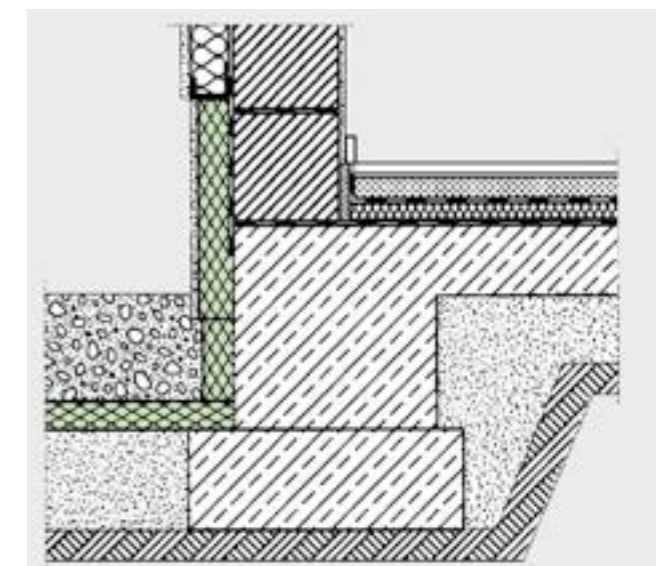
Possibilità di isolamento delle fondamenta contro il gelo.
